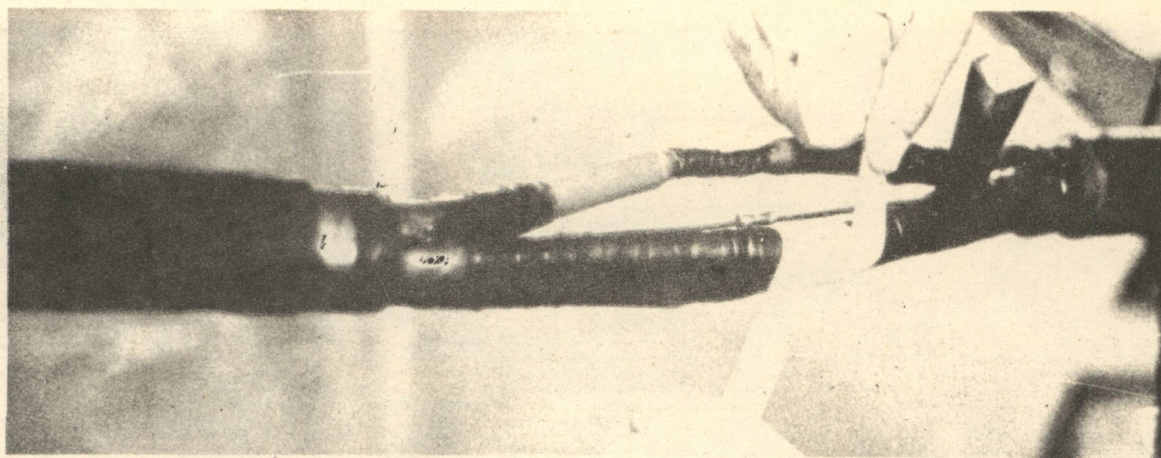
Przygotowanie końca kabla ekranowanego typu YHKXy do montażu w mufach przelotowych
